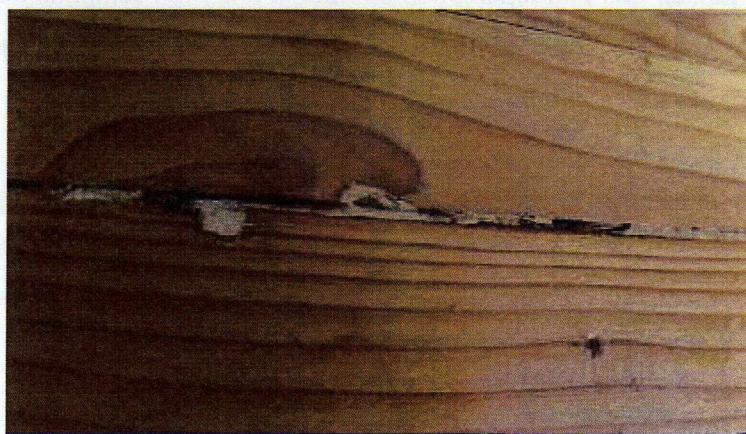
Deterioro y separación de junta entre componentes de madera laminada en viga de sala fitness.
